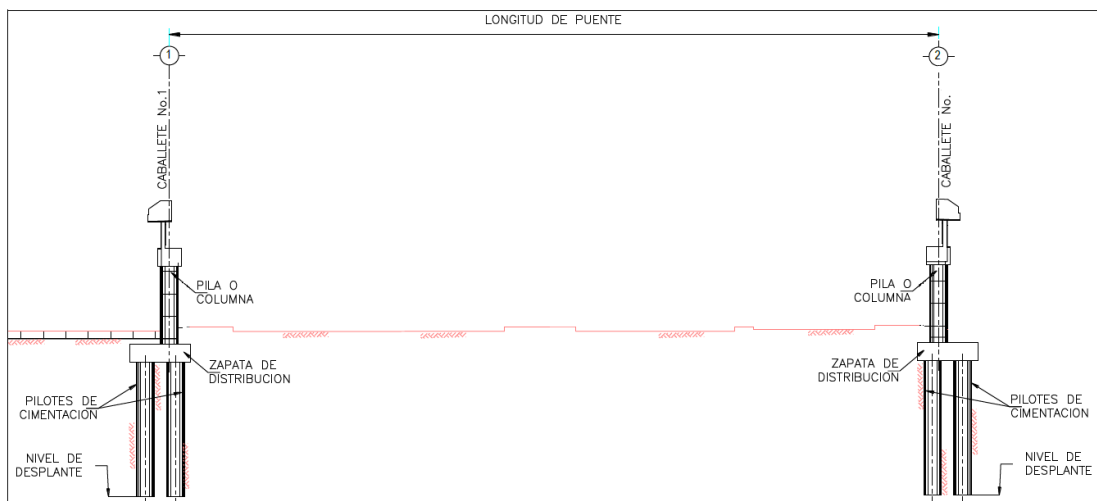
Partes representativas de la subestructura de Puente, tomado de la Guía de exploración y elaboración de estudios y proyectos para la cimentación de puentes, SCT 2014.
